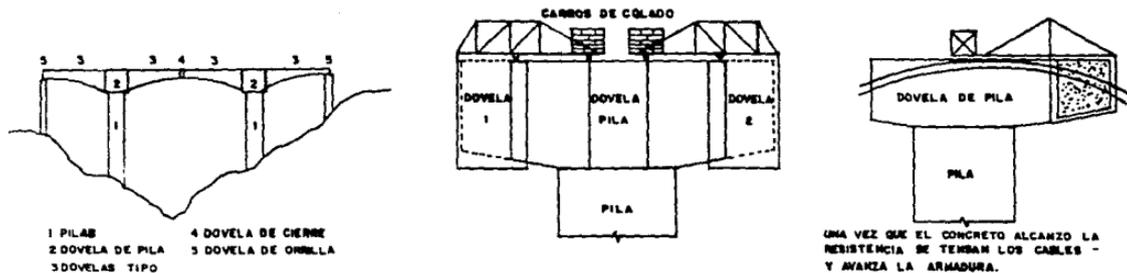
CONSTRUCCION EN DOBLE VOLADIZO
